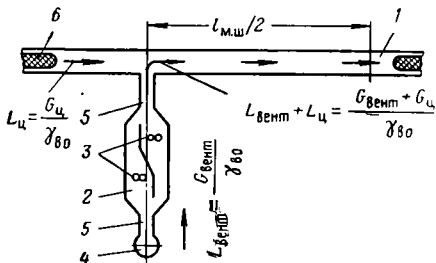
VIII. Схема системы вентиляции тоннелей при параллельной работе вентиляторов и поршневого действия поездов:
